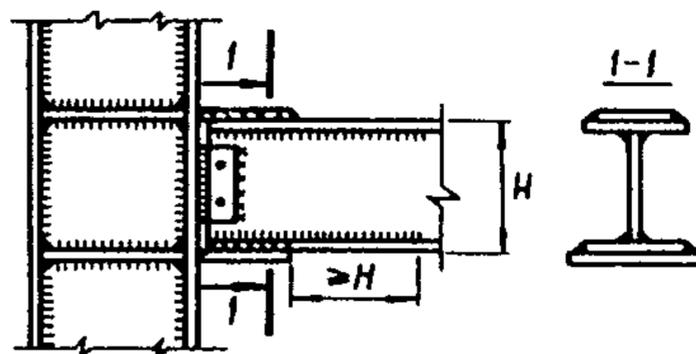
Расположение двустороннего поясного шва в опорном узле ригеля
